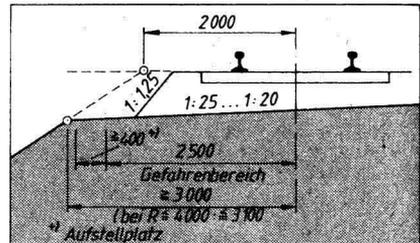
Hauptmaße des Bahnkörpers («halbe Breite»)
